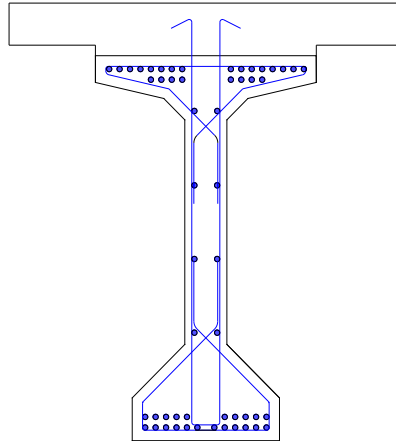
Visualización del acero de refuerzo longitudinal superior e inferior de la sección viga para cargas transitorias y peatonales
